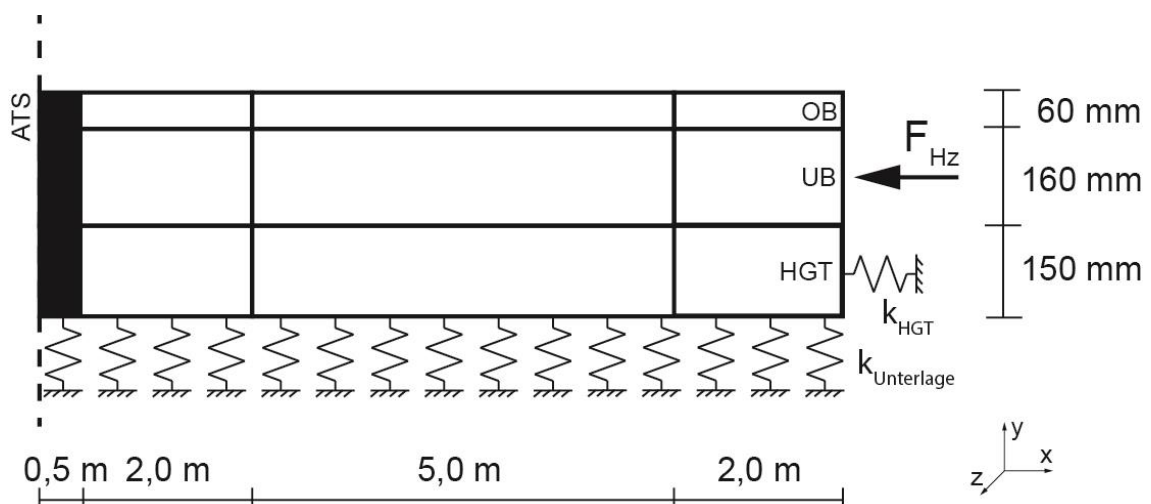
Finite-Elemente-Modell mit ATS-Streifen – Lagerung mit Verbund zwischen Beton und HGT (halbseitige Darstellung)
